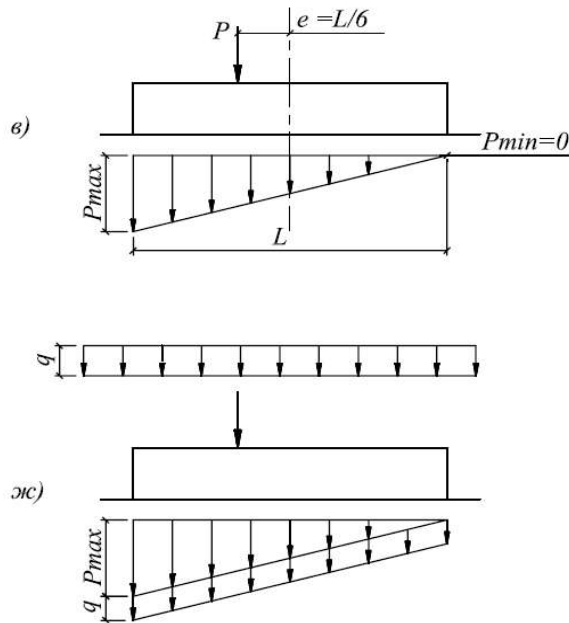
Эпюры давлений по подошве фундаментов при внецентренной нагрузке. в и ж – при  $e = \frac{l}{6}$
